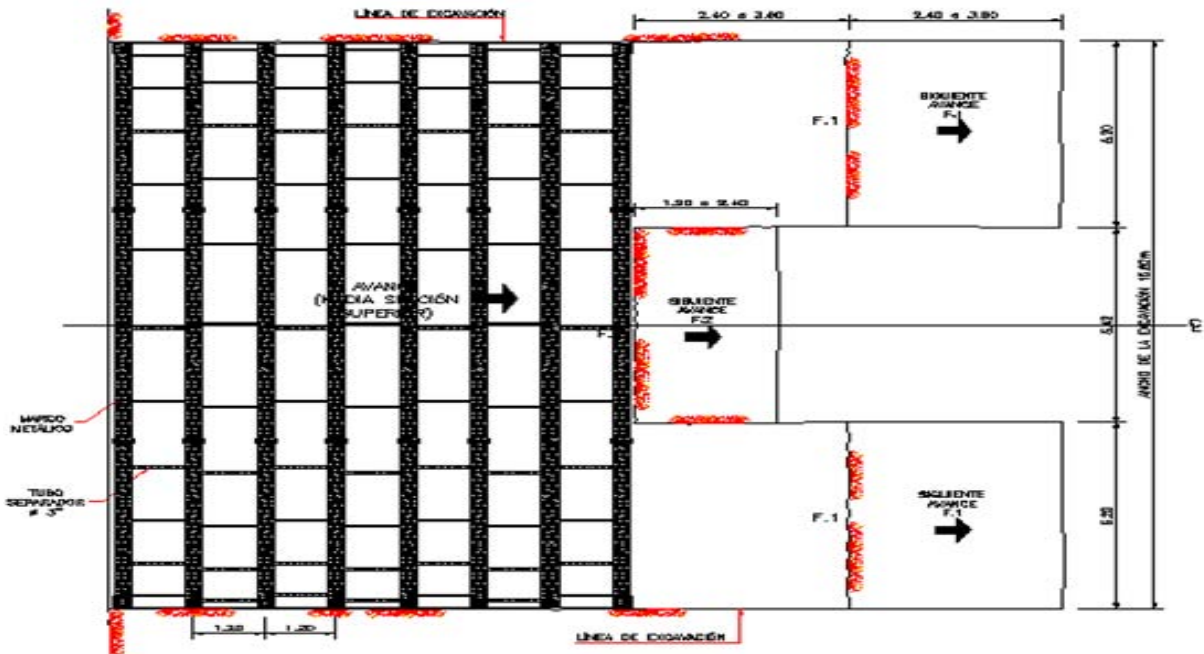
Planta del túnel donde indica las fases de avance de excavación
